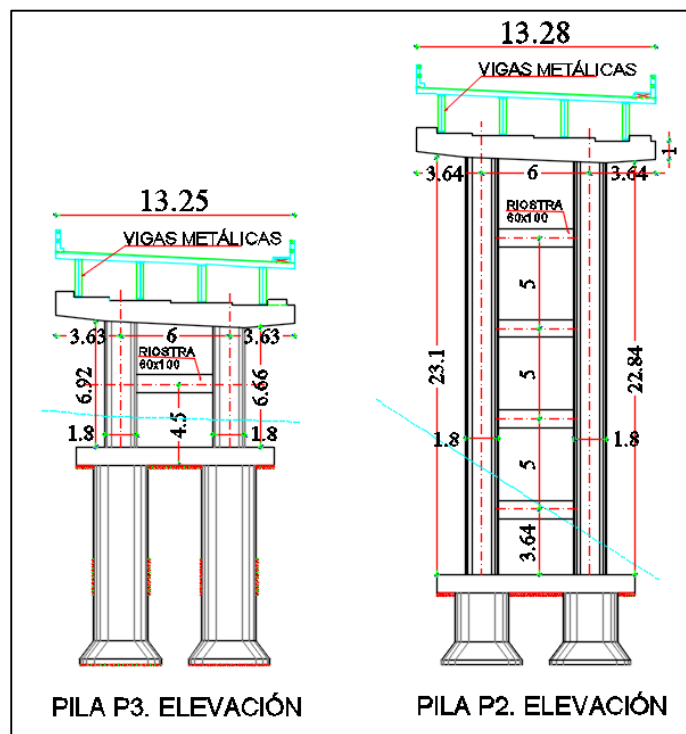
Detalle en elevación Pilas P3 y P2 (Tramo A2).
